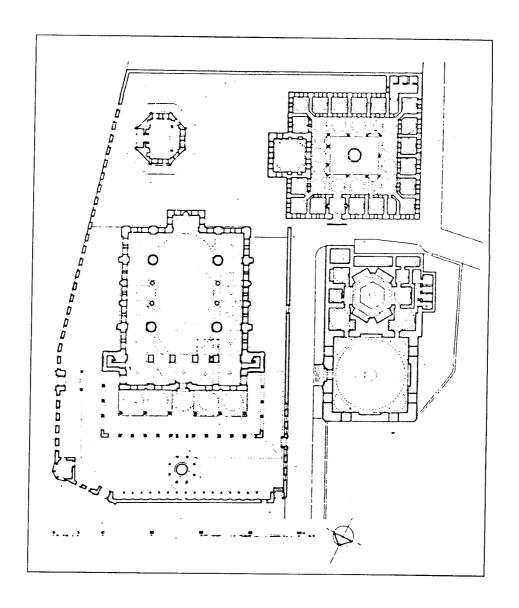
مسقط أفقي لحمام محمود باشا بإستانبول (عن : جودوين) .
